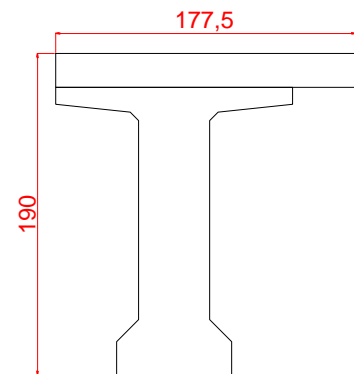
Coupe transversale de la poutre d'about rive avec hourdis.
